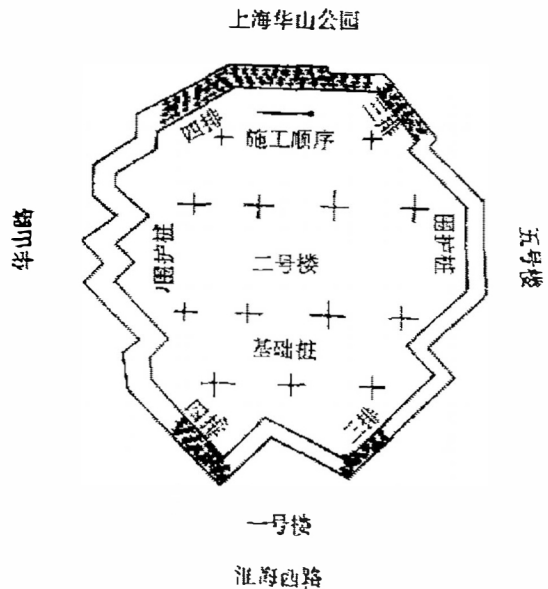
华山路高层住宅区二号楼围护桩施工平面示意图
